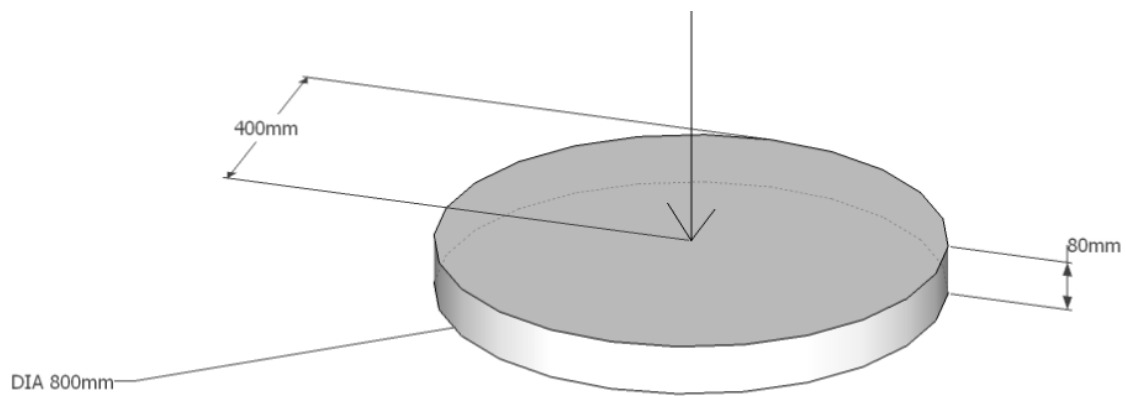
Dimensions d'une dalle circulaire ASTM
